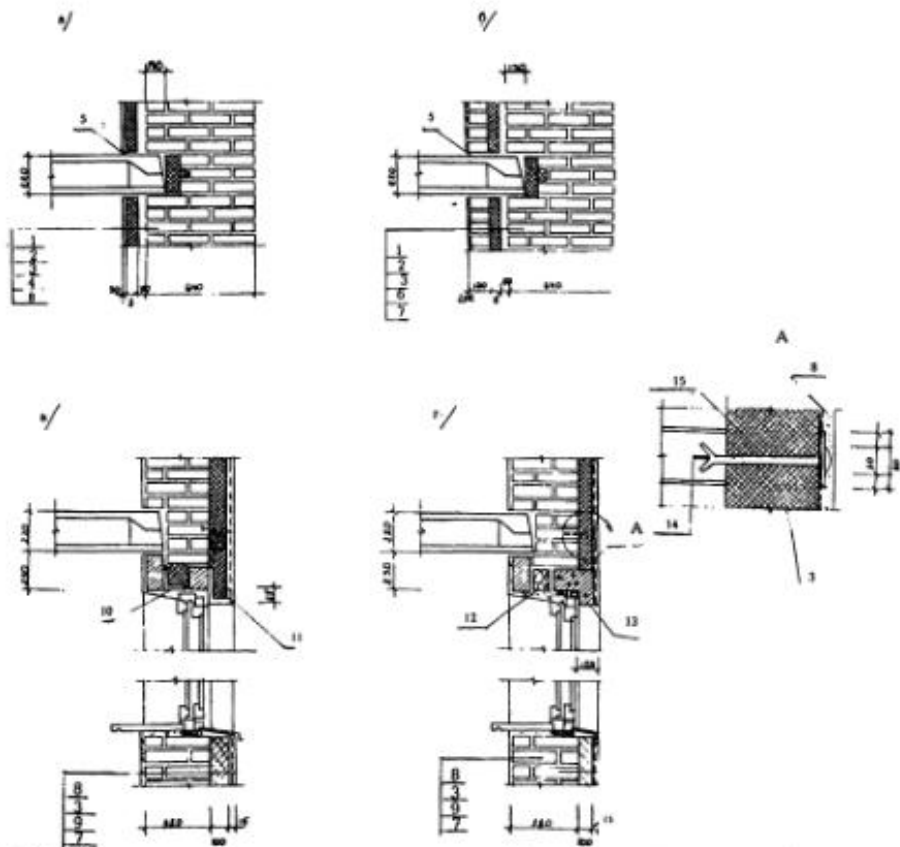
Сплошная кладка с утеплителем с внутренней или наружной стороны: а, б - варианты конструкции междуэтажного узла с утеплителем с внутренней стороны; в, г - варианты конструкции междуэтажного узла с утеплителем с наружной стороны; 1 - кирпичная кладка; 2 - воздушная прослойка; 3 - утеплитель по деревянной обрешетке; 4 - гипсокартонная плита; 5 - щель воздухообмена; 6 - внутренний слой кладки; 7 - штукатурка под обои; 8 - паропроницаемая штукатурка на клеящей основе; 9 - кирпичная стена; 10 - стальной уголок; 11 - гнутый металлический профиль; 12 - деревянный брусок; 13 - керамзитобетонная перемычка; 14 - болт; 15 - анкер
